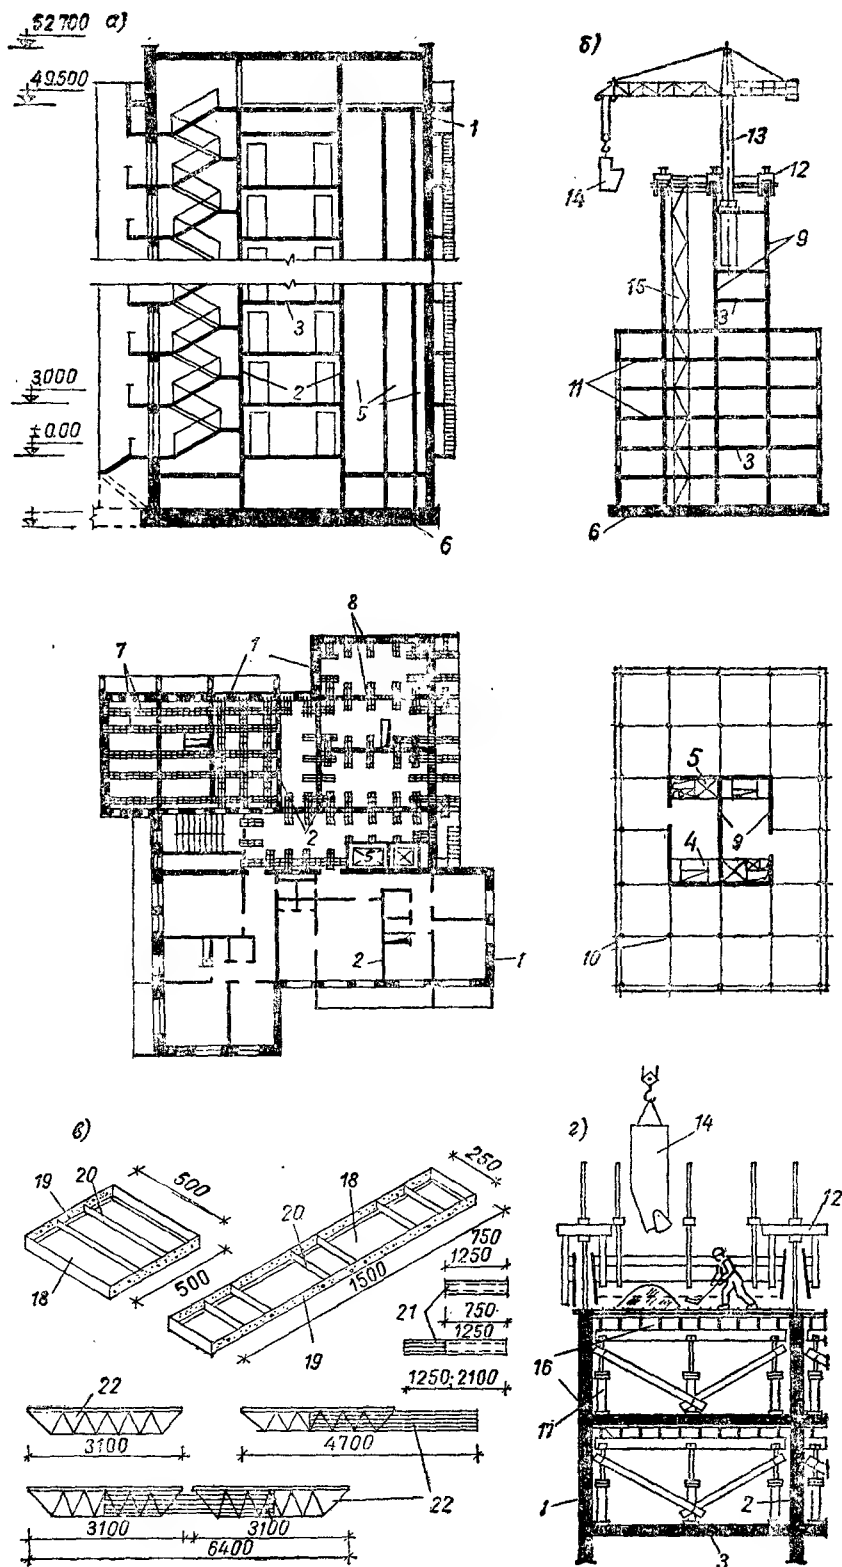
Здания из монолитного железобетона и типы инвентарной опалубки
